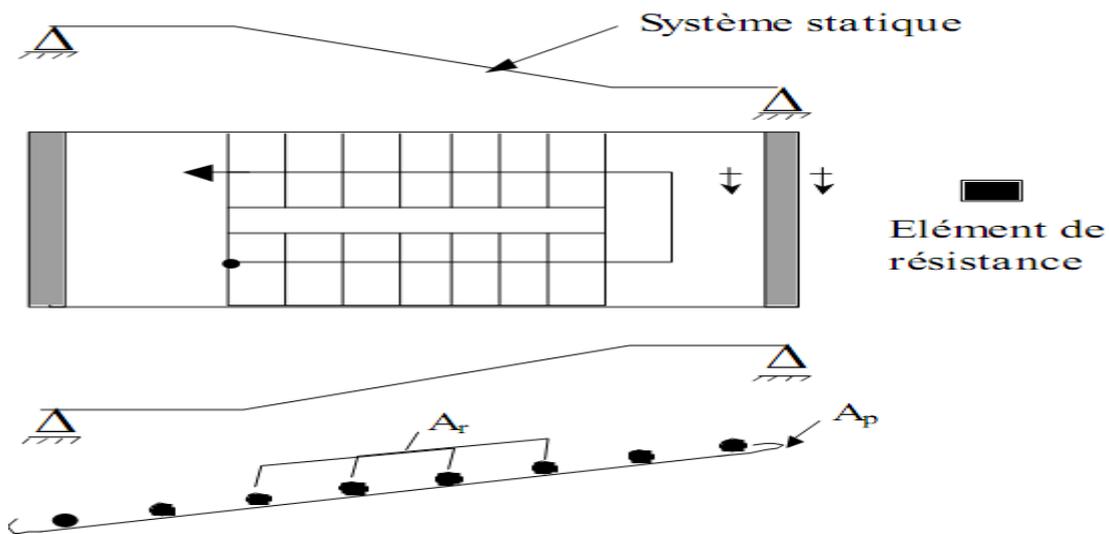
Système statique (Les paliers et la paillasse s'appuient sur les éléments de résistance).
